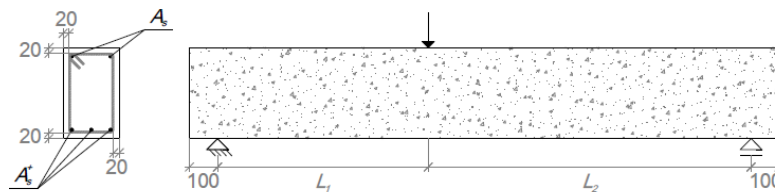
Geometria e condições de carregamento das vigas ensaiadas por Barros e Costa (2009) (dimensões em milímetros).
